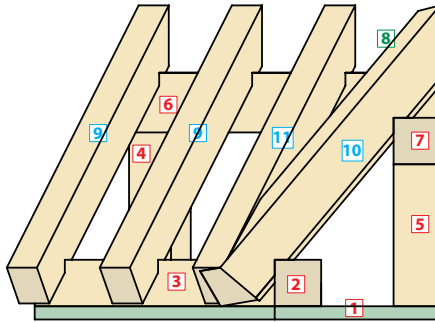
Das Nebendach schließt nicht rechtwinklig an das Hauptdach an. Die Dachneigungen sind unterschiedlich.
